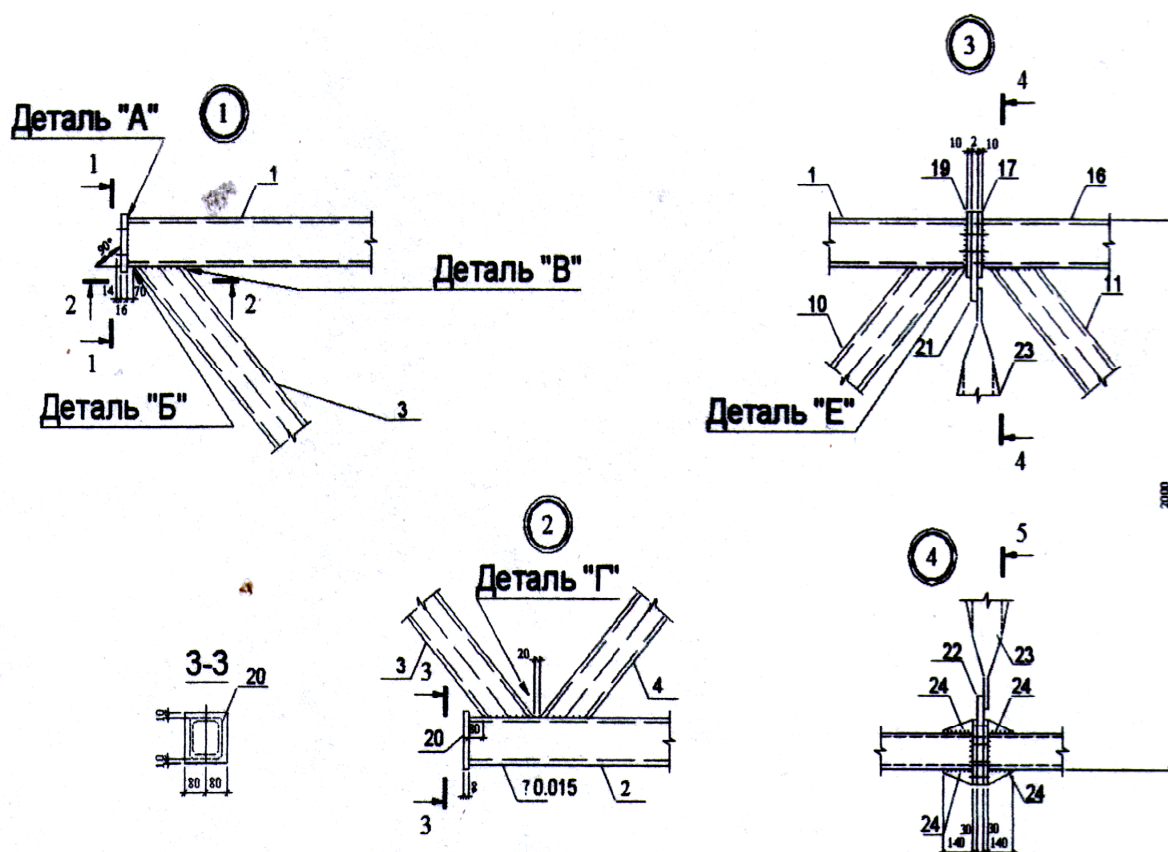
Вузли поєднань стержнів решітки і поясів ферми з ЛМК
